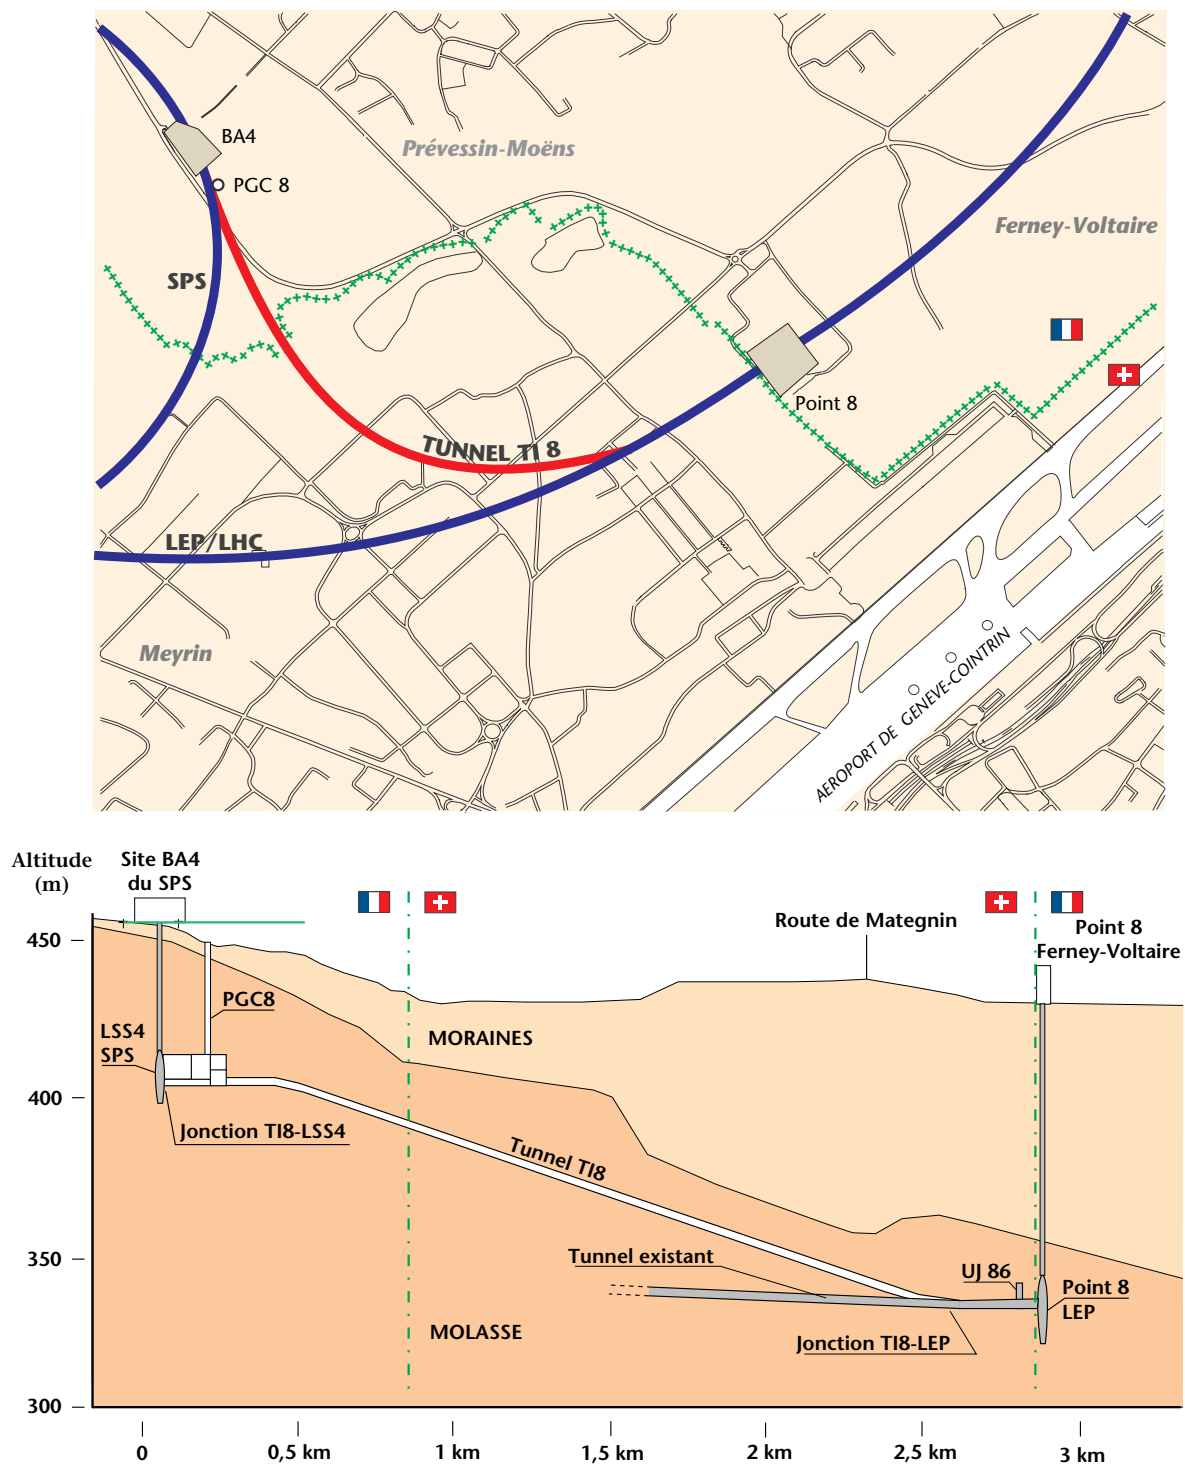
Plan de situation et profil longitudinal du tunnel de transfert T1 8
